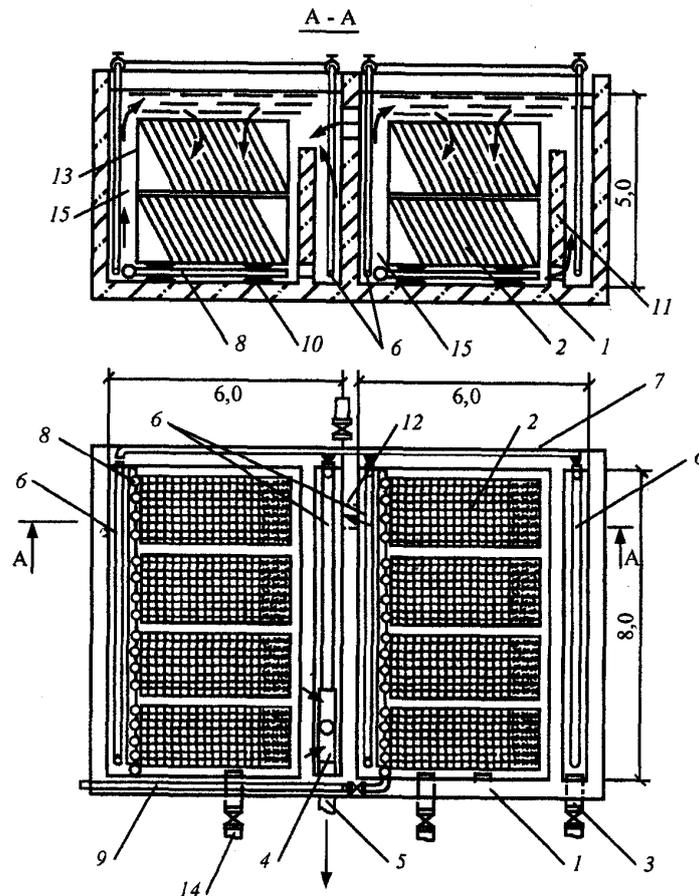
Фильтр-биореактор с загрузкой из стеклоершей:
